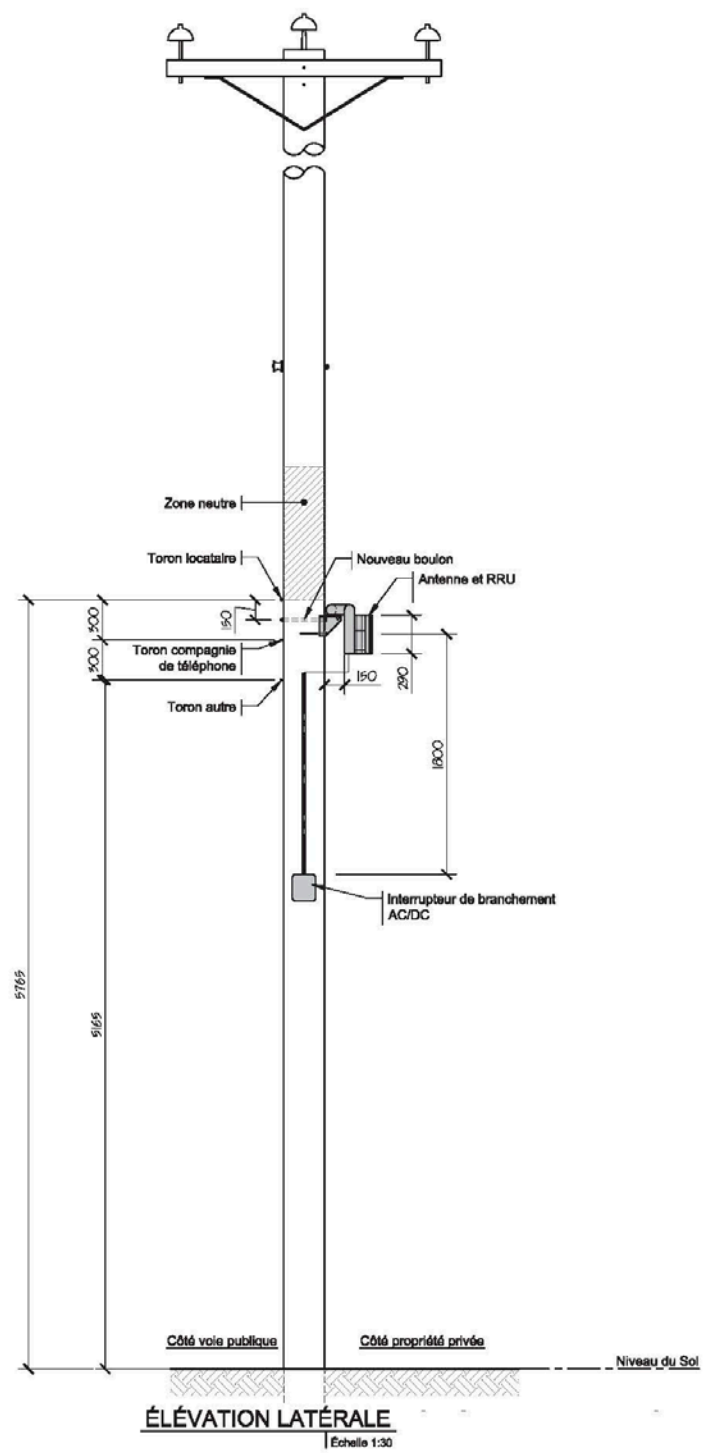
Installation d'une antenne sur un poteau avec hauban
